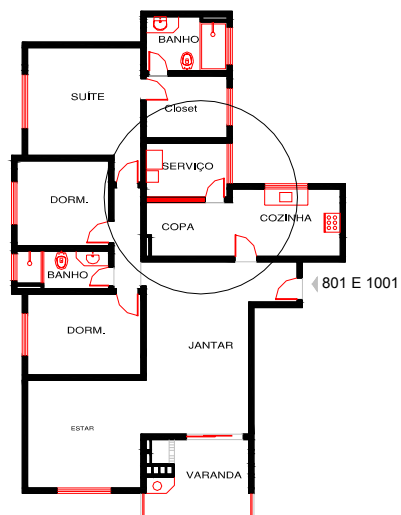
Planta Baixa dos apartamentos 801 e 1001 – Estudo de caso A.
